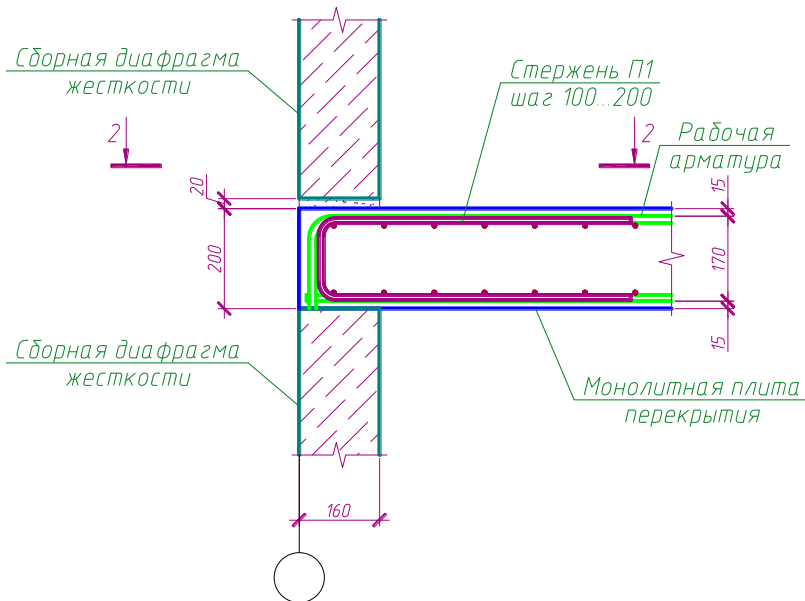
Вариант 2. Опираение монолитного диска перекрытия на сборные внутренние стеновые панели
